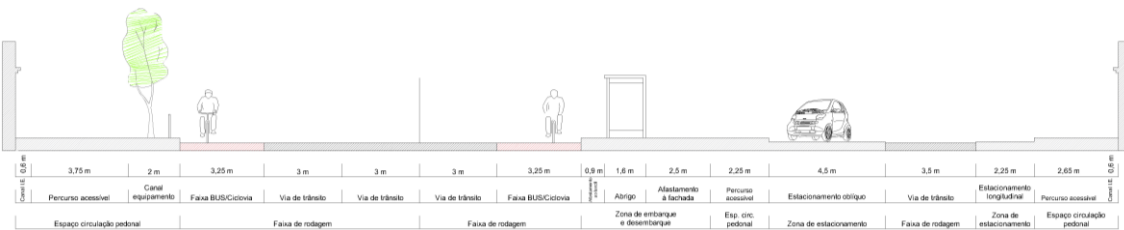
SECÇÃO PROPOSTA I-I'
